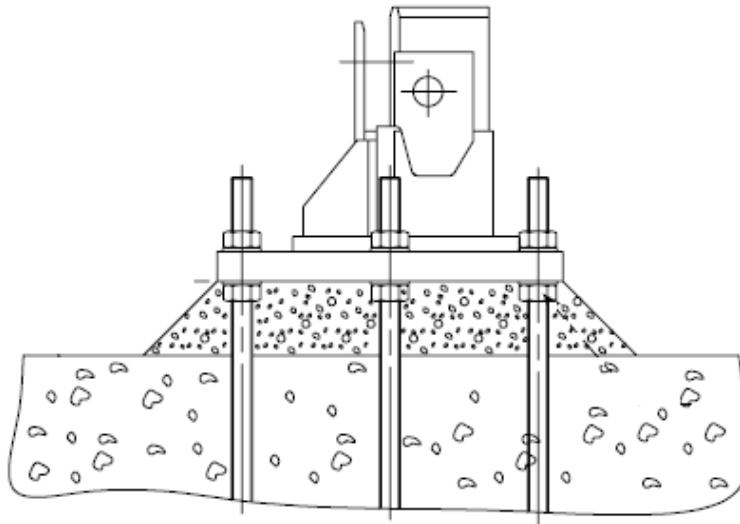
Detalle de amarre de los pies recuperables
